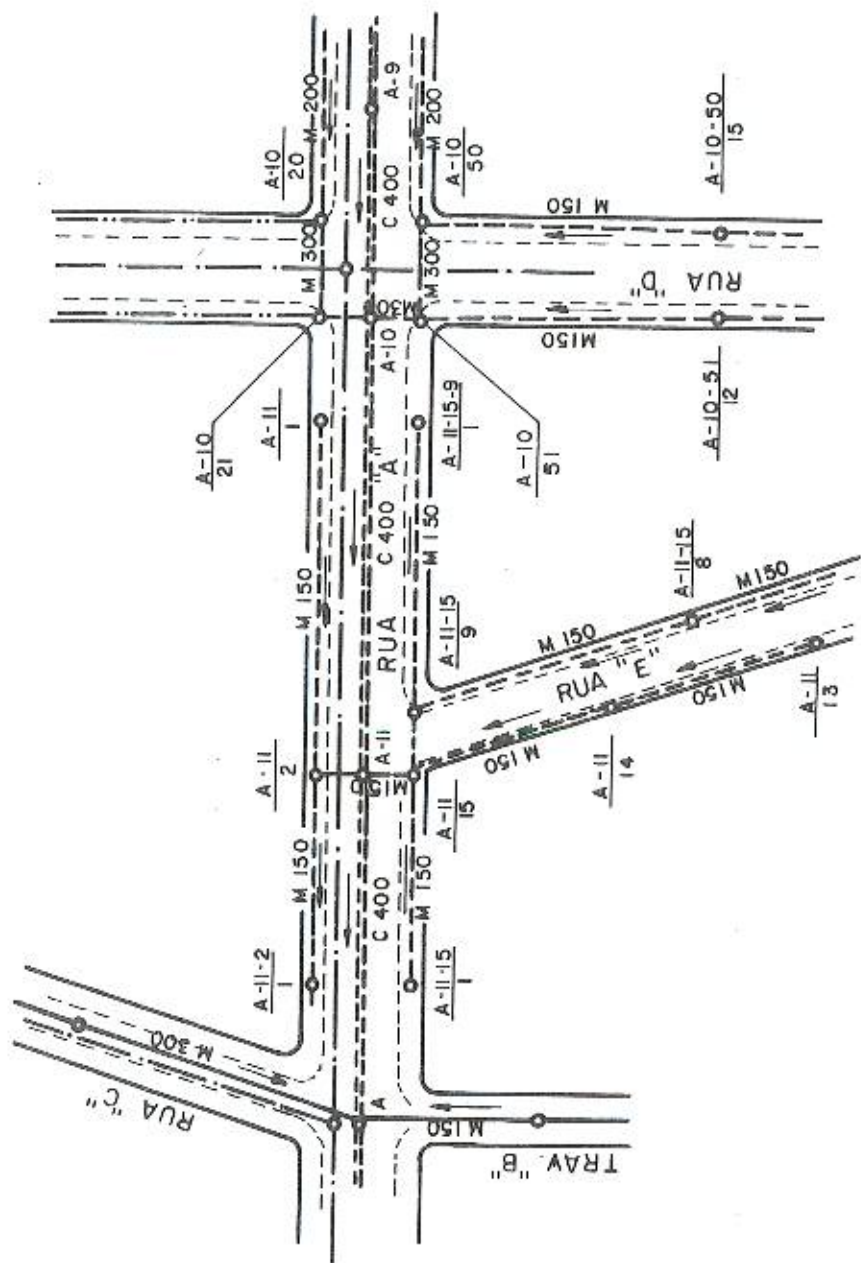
A — Planta baixa de projeto — esc. 1:1.000.
